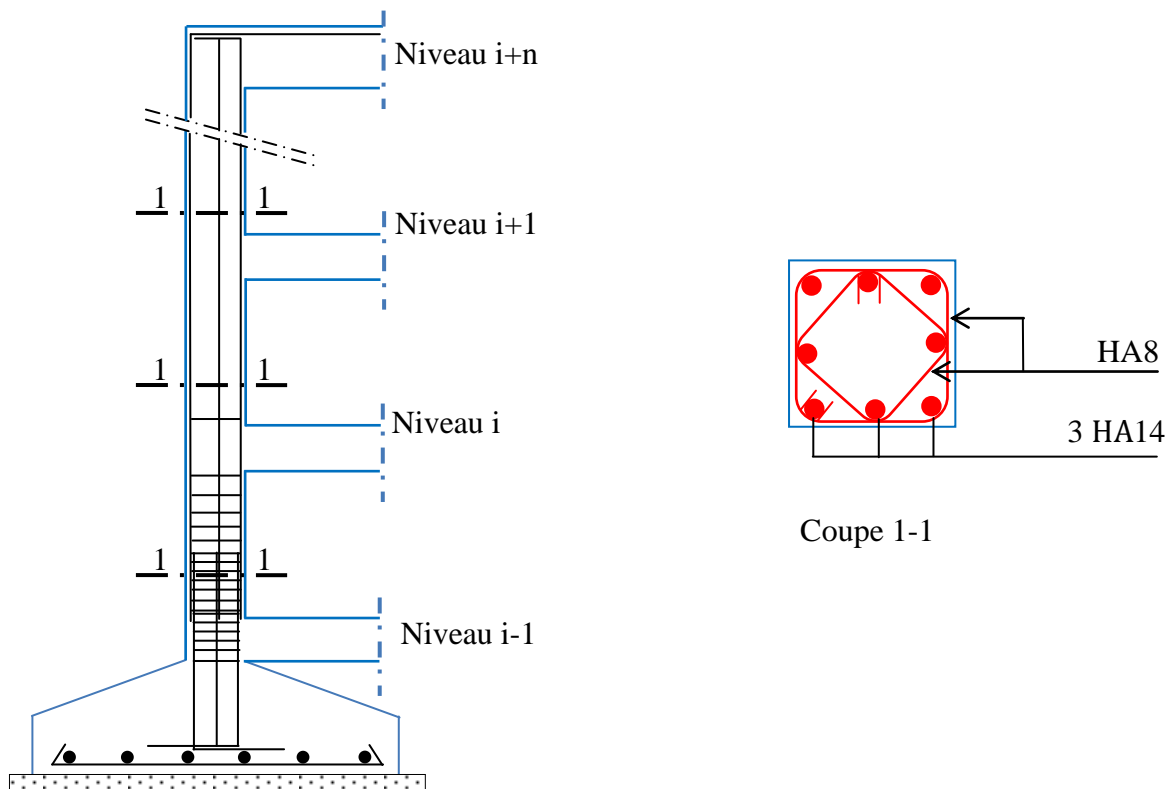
Coupe B-B. Détail de ferrailage des poteaux
